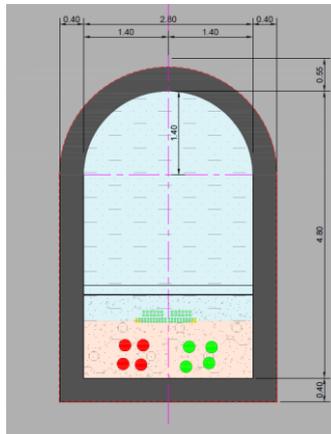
Rameau – coupe transversal en considérant l'adaptation du radier plat
